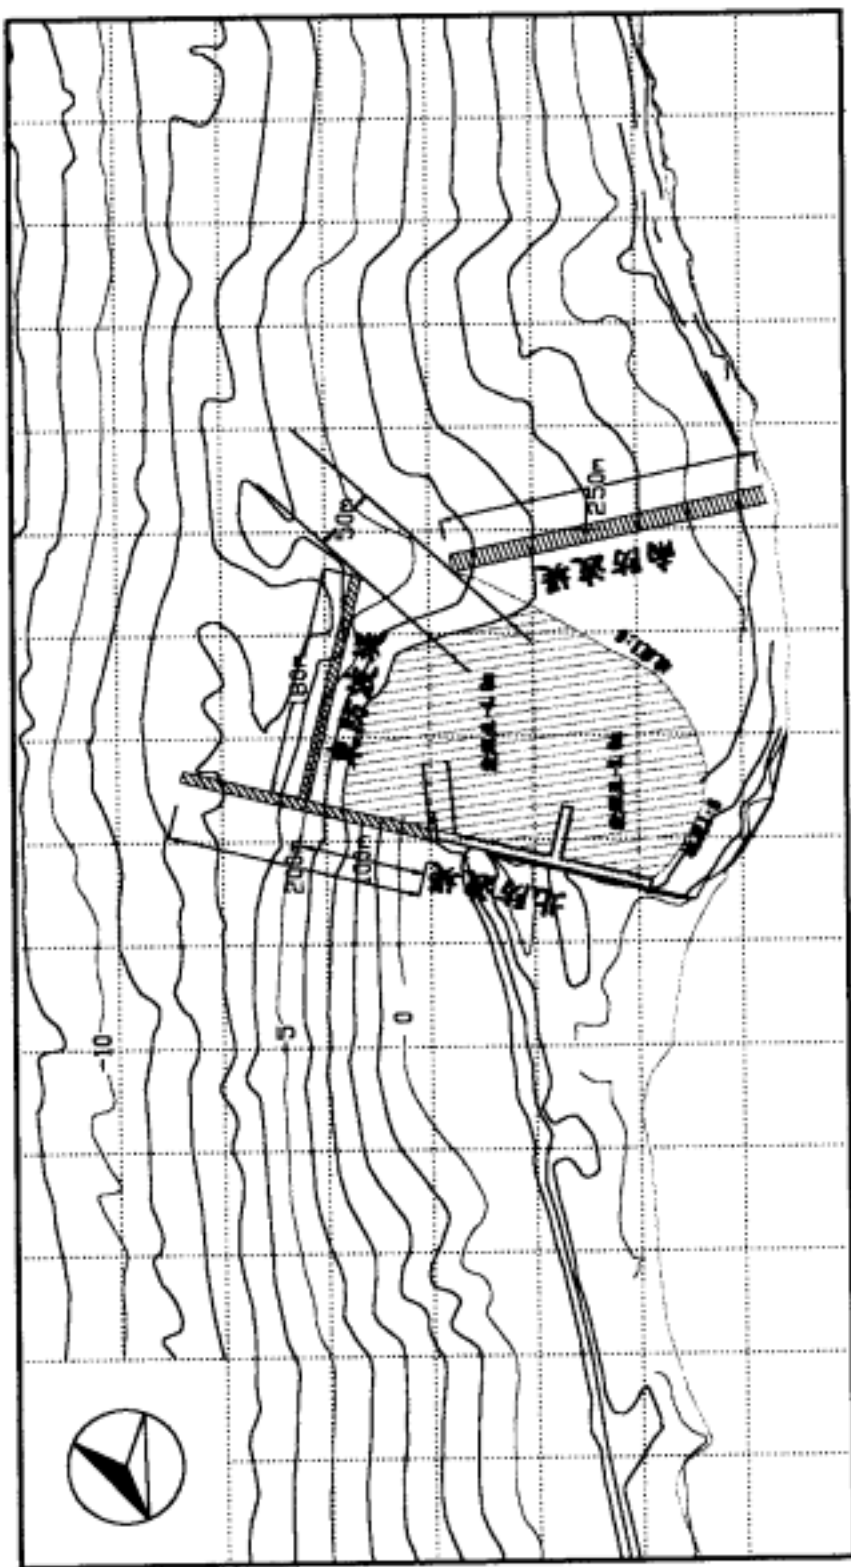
改善配置 D 試驗的防波堤配置示意圖
